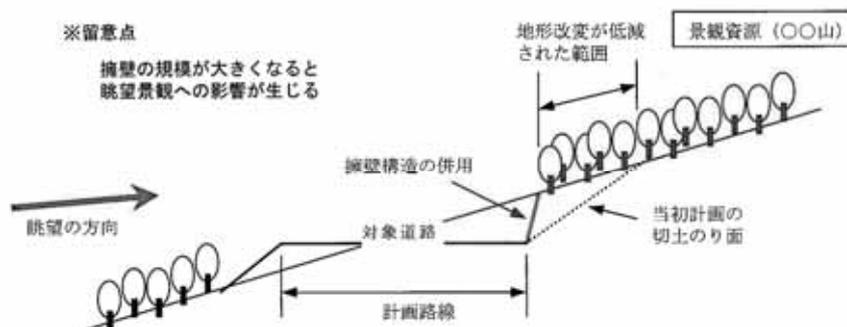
擁壁構造の併用による地形改変の低減の例
